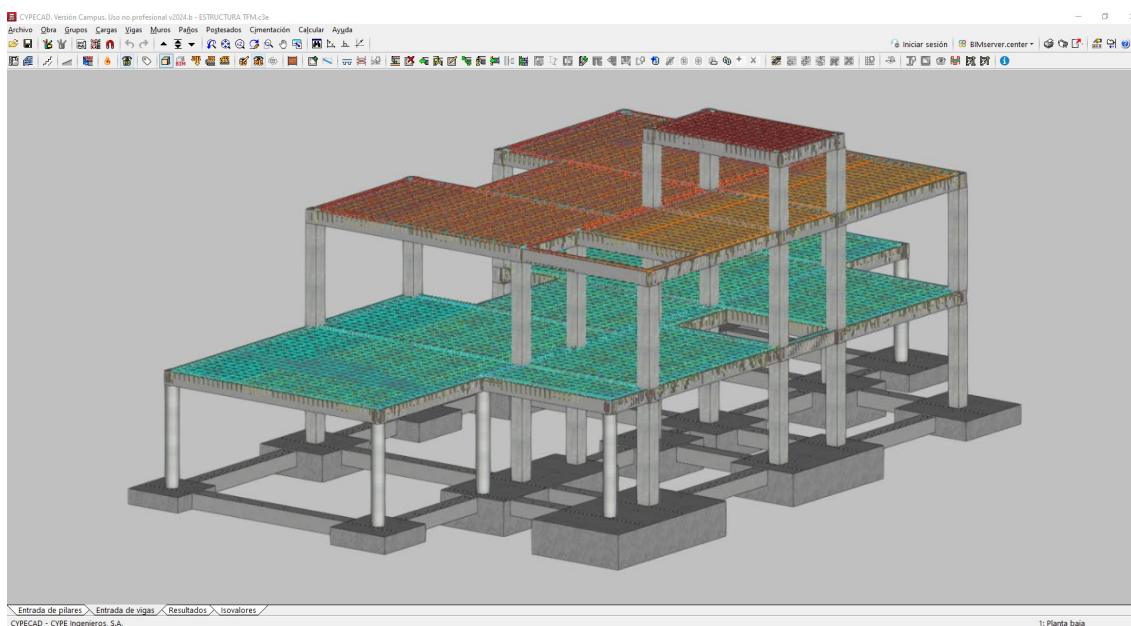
Structura din beton armat a casei unifamiliale în CypeCAD
